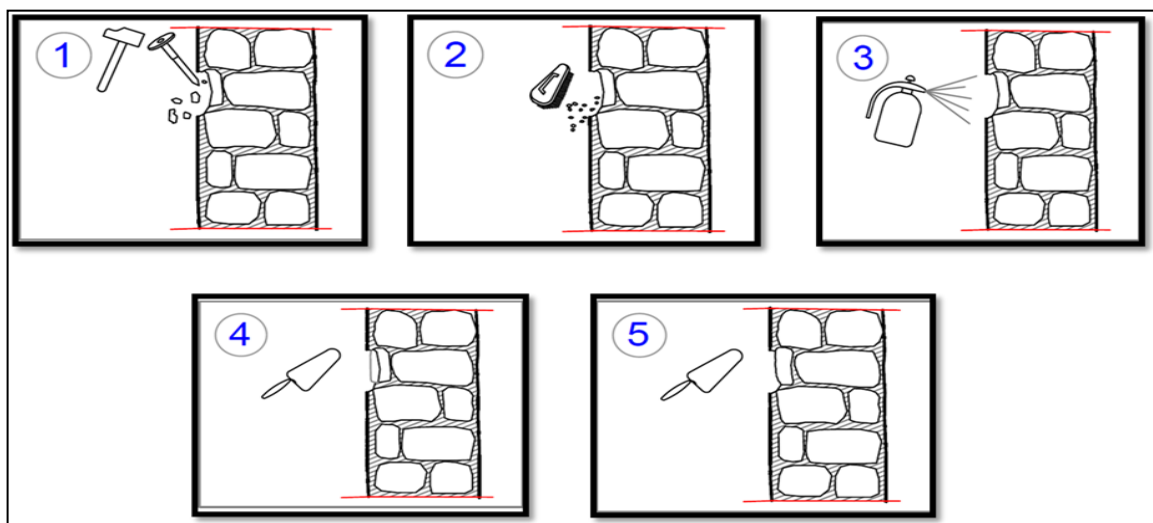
les etape du Restauration d'une partie d'un mur effondrement source : Auteurs
